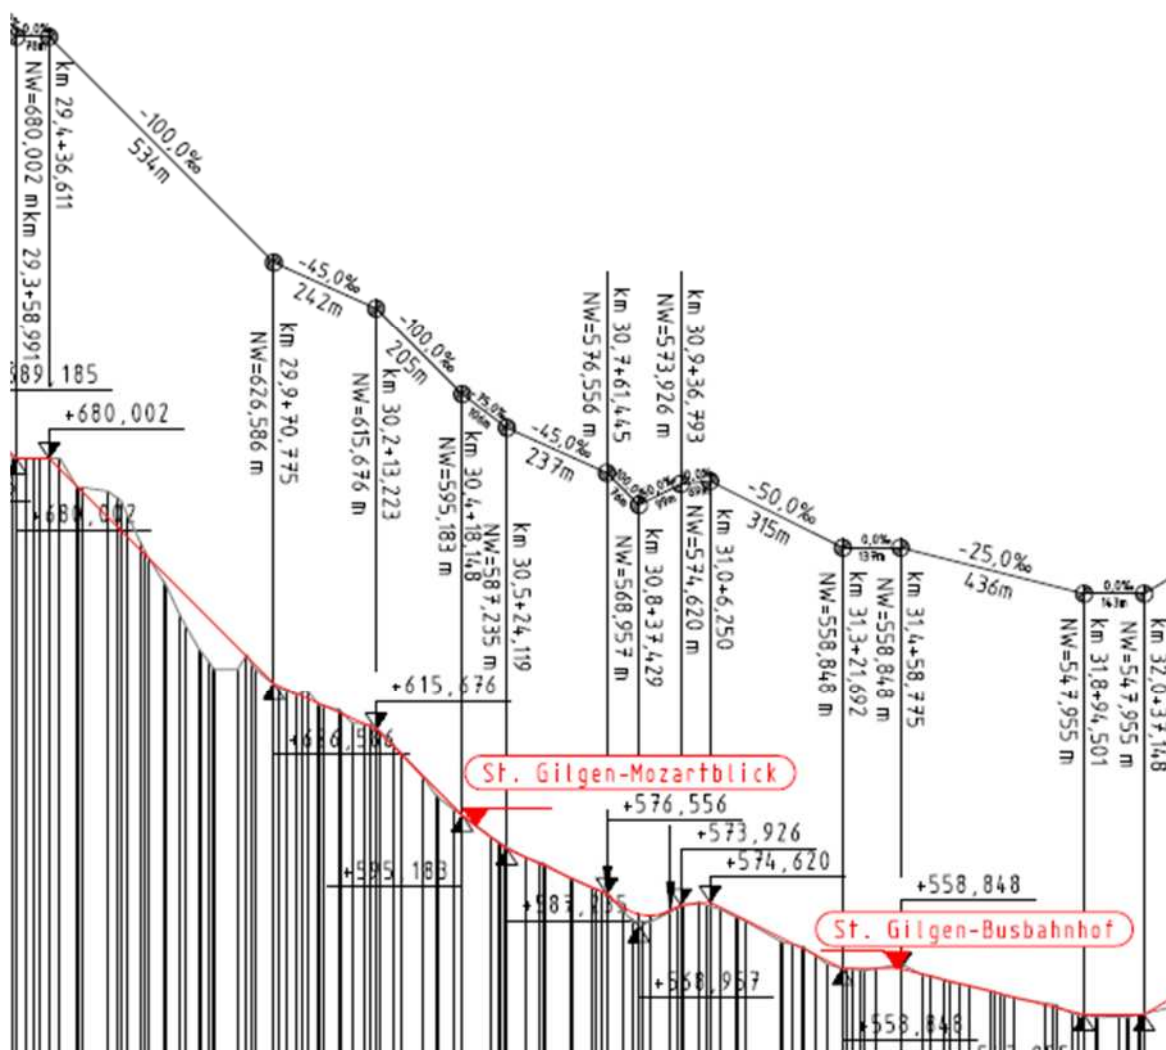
Höhenplan (Ausschnitt o. M.) im Bereich St. Gilgen
